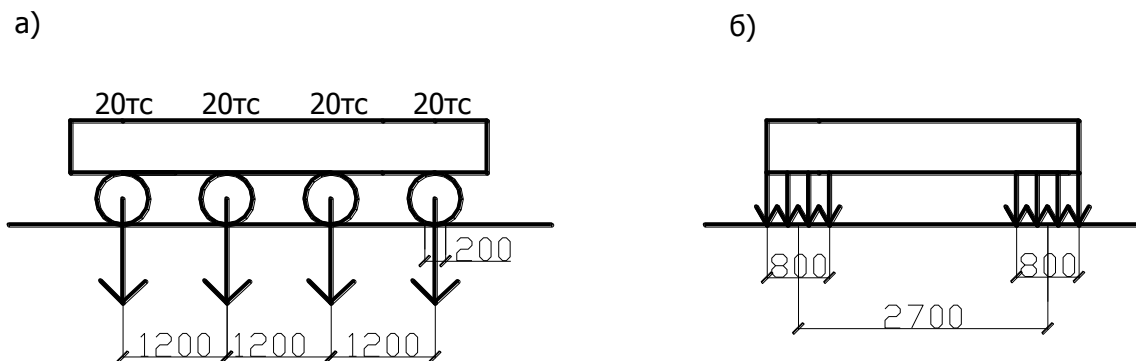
Схема подвижных нагрузок НК-80 а) вдоль движения, б) в поперечном направлении
